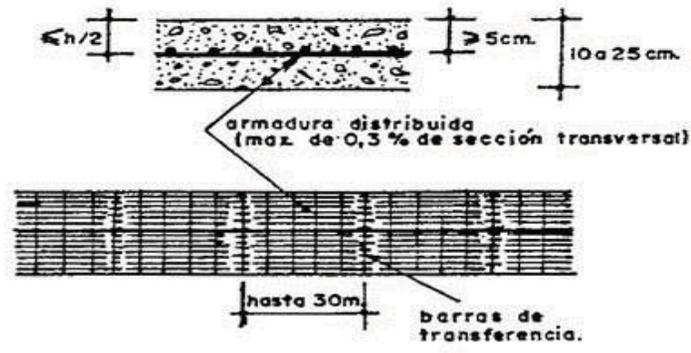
Estructura de un pavimento rígido reforzado con acero no estructural.
